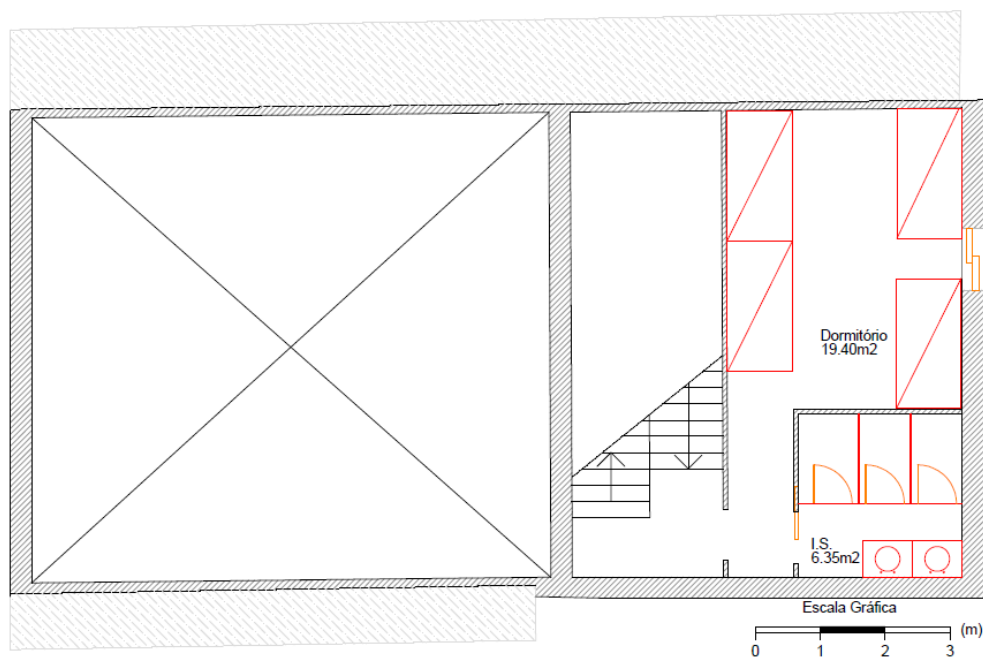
Planta do Piso 1 do Edifício Reabilitado
